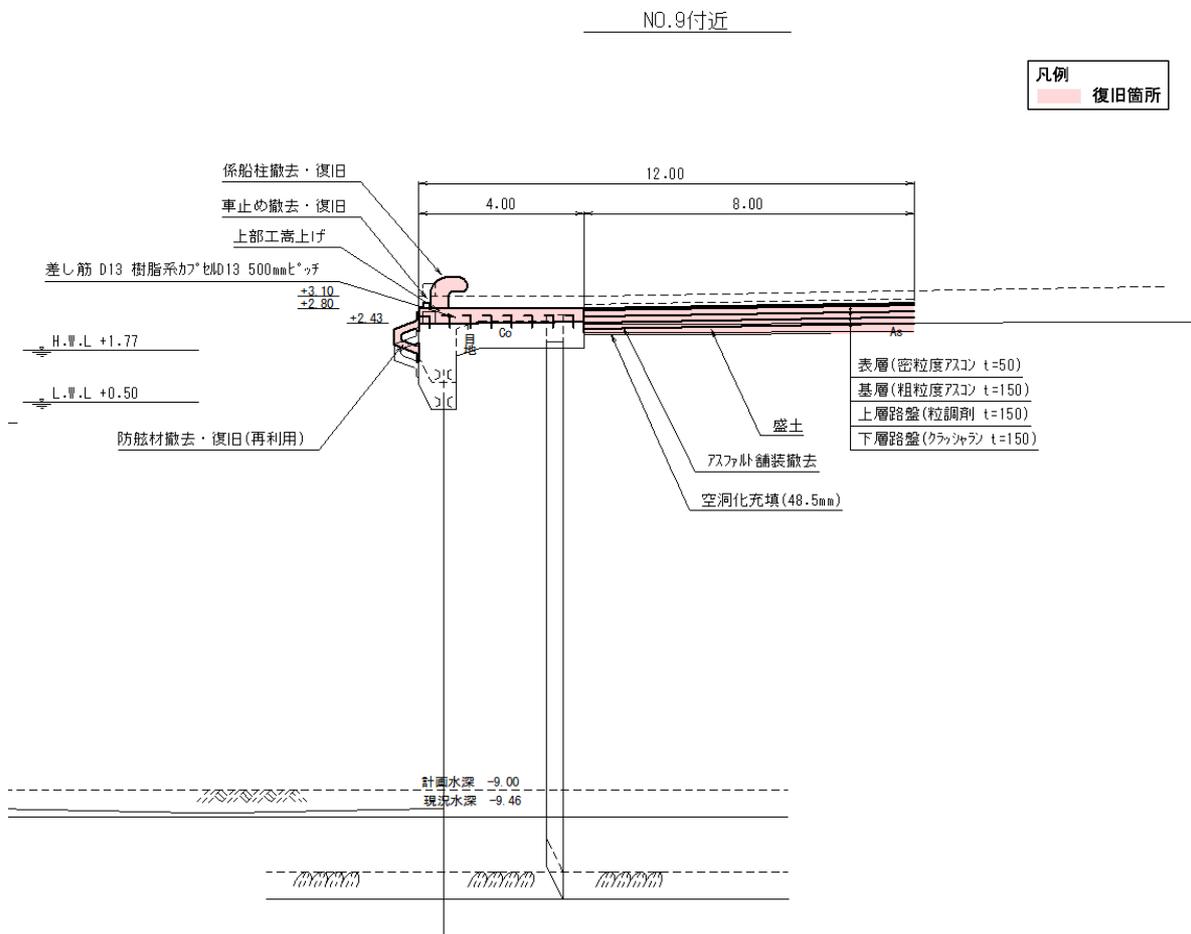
塩釜港区\_貞山ふ頭1号岸壁の断面図 (標準部) (被災後, 復旧後)
